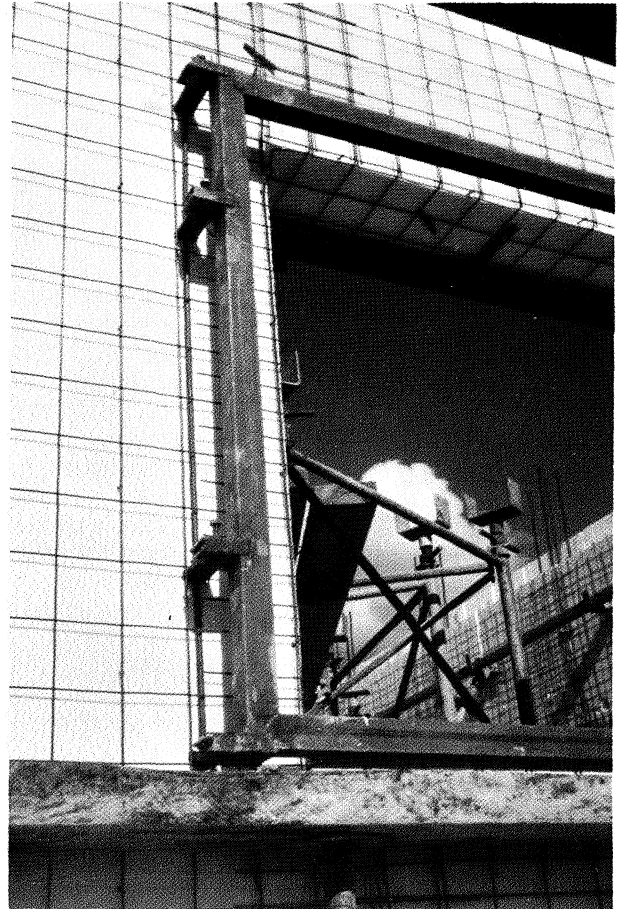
Util para replanteo y fijación de anclajes para rejas.
